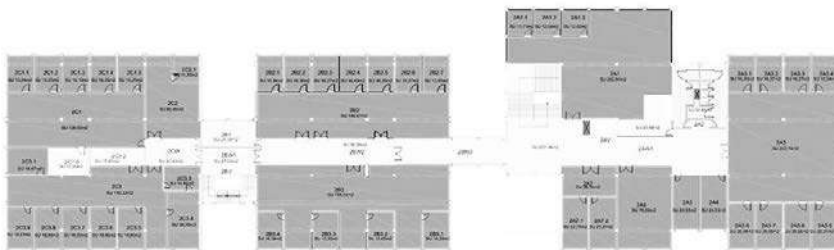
PLANOS DE PLANTA DE LOS EDIFICIOS
